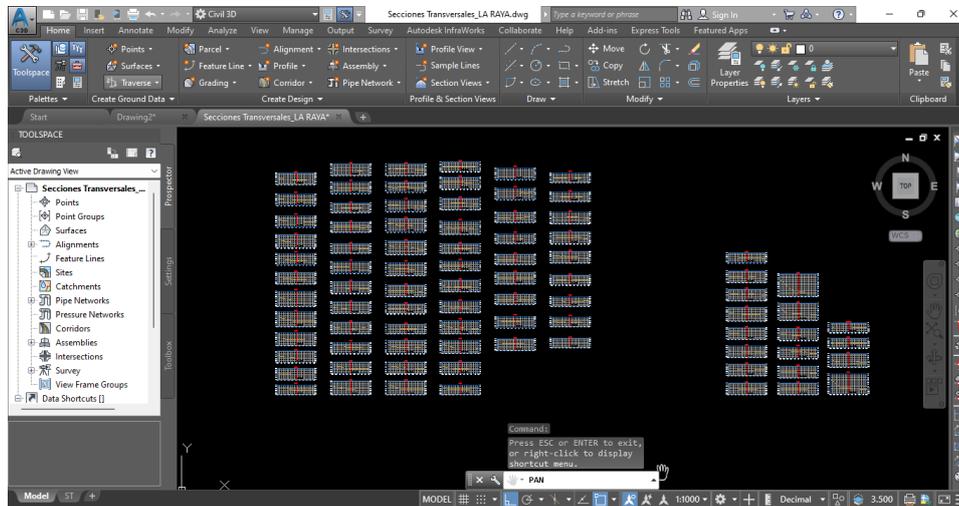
Trazo de Perfiles longitudinales y Secciones Transversales
